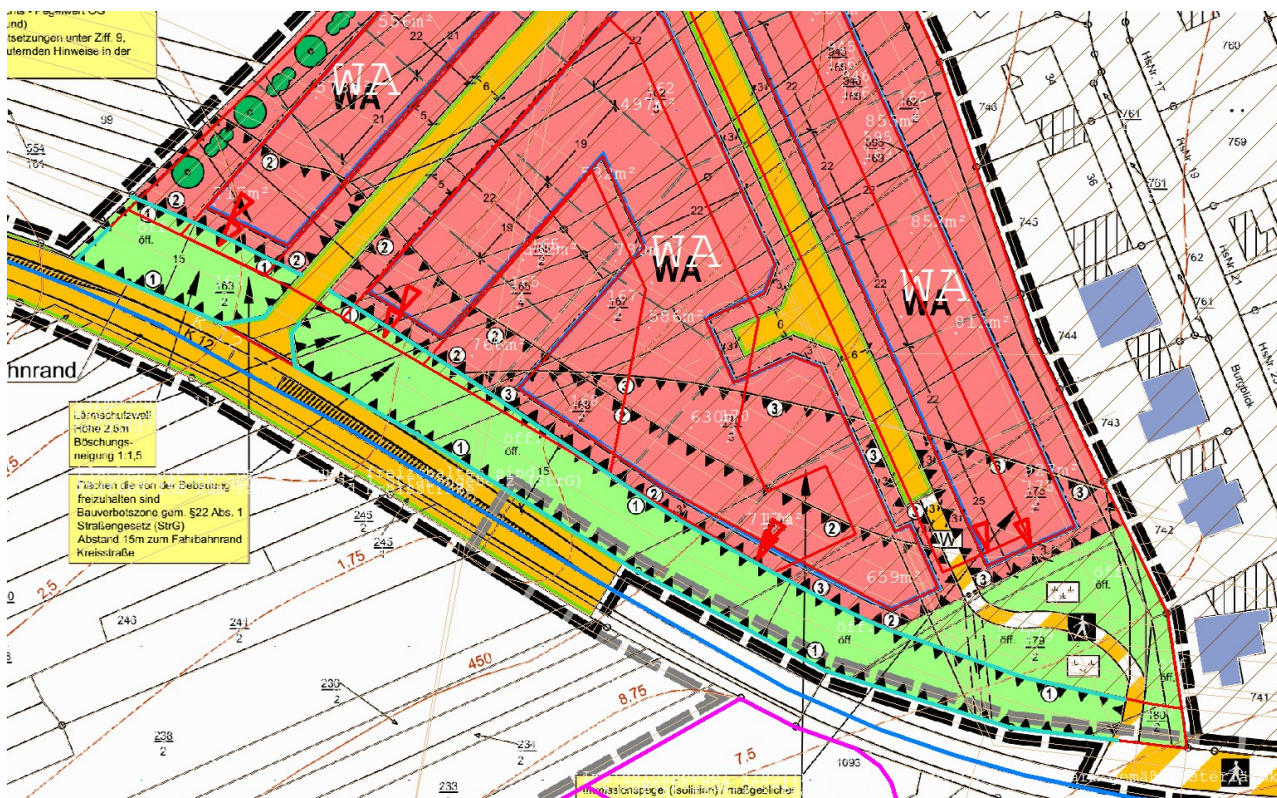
Lageplan mit aktuellem Bebauungsplan sowie alten und neuen Baufenstern und Immissionsorten
